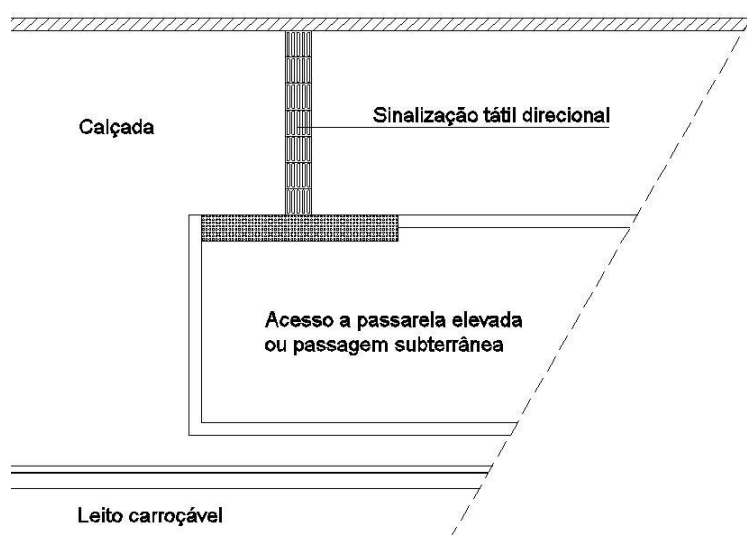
Passarelas elevadas e travessias subterrâneas em calçada sem sinalização tátil direcional
